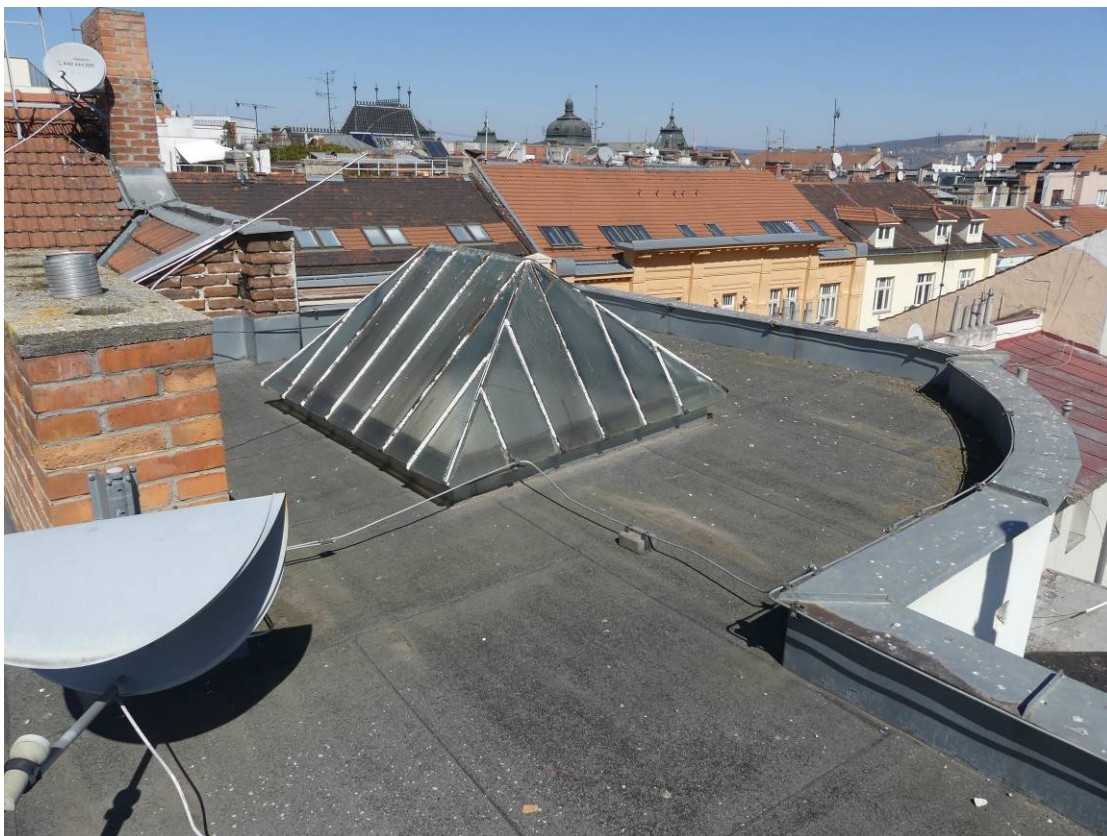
Pohled na plochou střechu jižní části objektu
